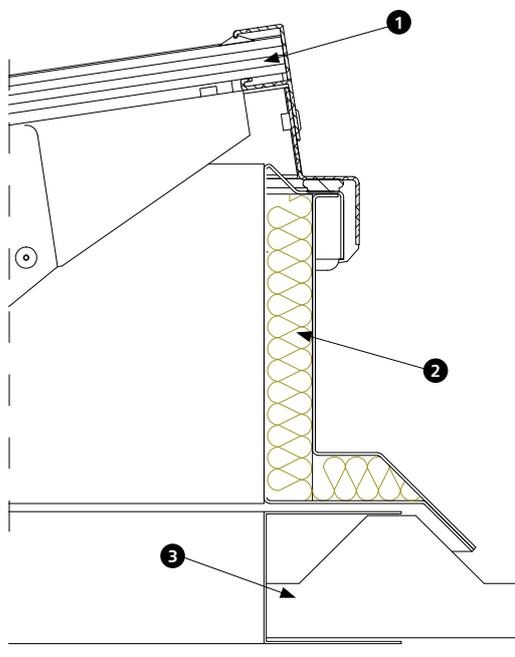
Montage des Lamellenlüfters auf Flachdachsystem mit Stahltrapezprofil
